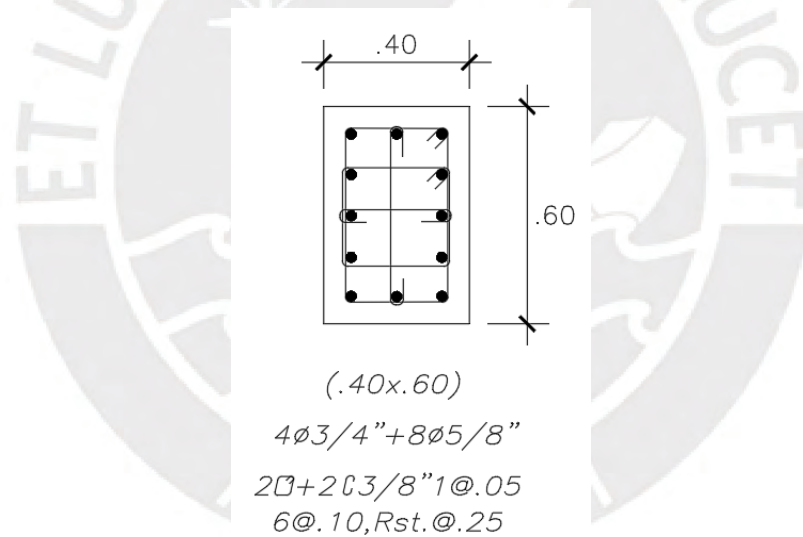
Diseño final de la columna C-1 para sistema de muros
